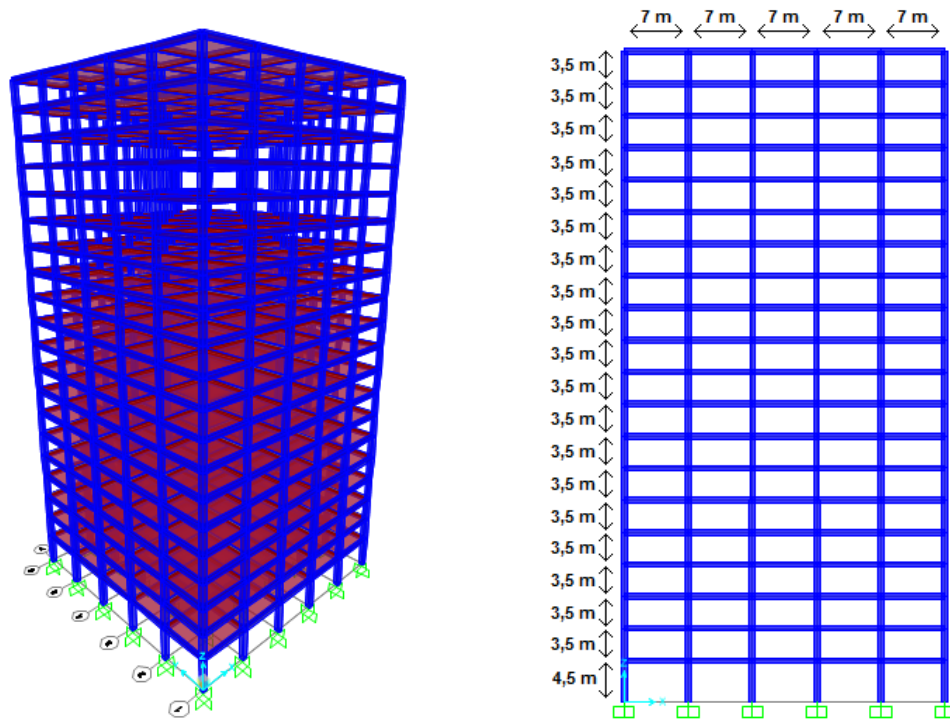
Geometría 3D y elevación exterior del edificio en base a pórticos
